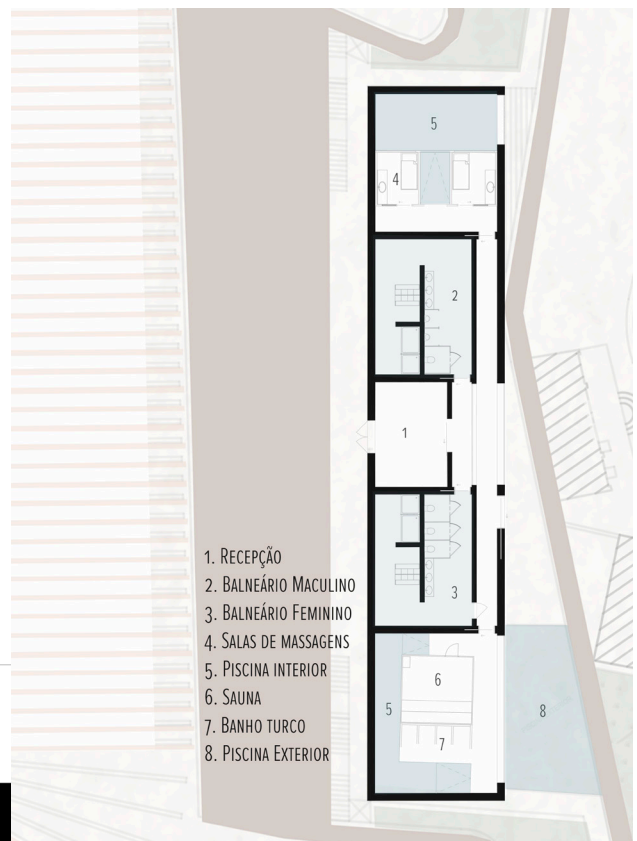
Spa. Planta elaborado pela autora. 2018.
